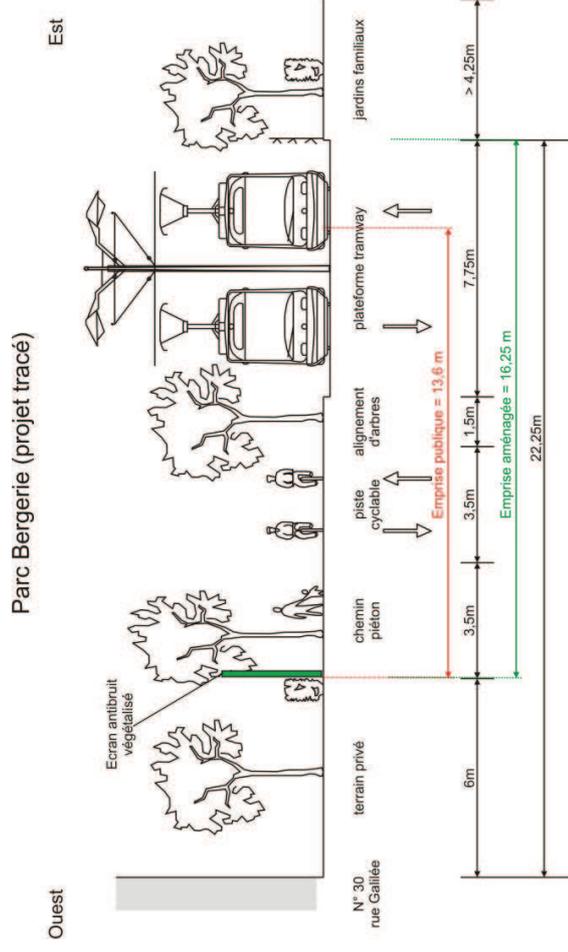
Situation projetée coupe 8 sur le parc de la Bergerie
